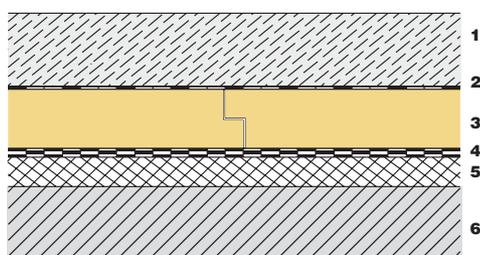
Stratigrafia di tetto rovescio carrabile con pavimentazione in calcestruzzo armato
